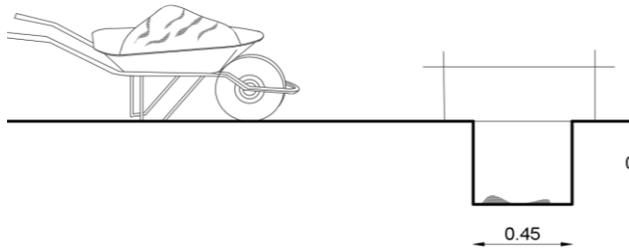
Excavación de zanja para cemento. Fuente: Elaboración propia
